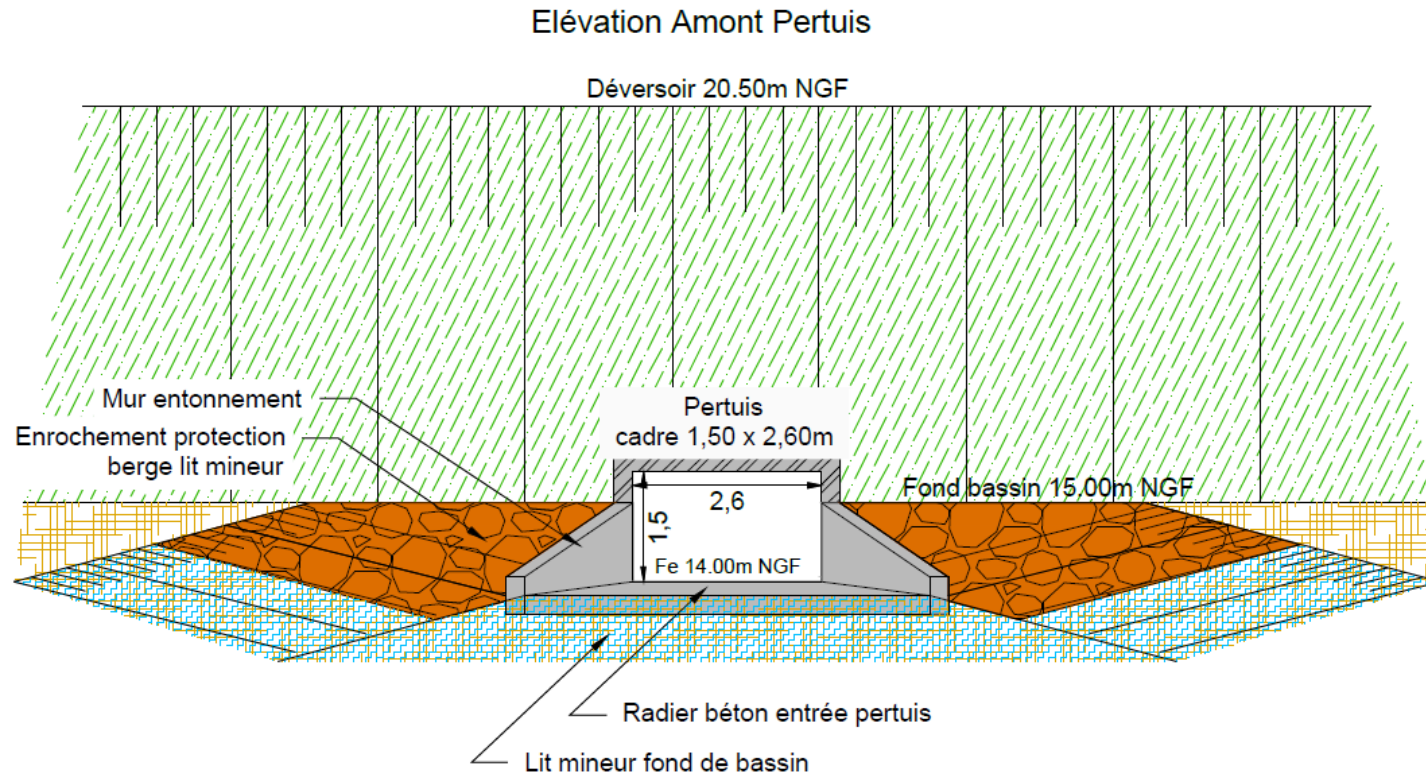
Profil en travers au droit du pertuis de fond, face amont – plan AVP
